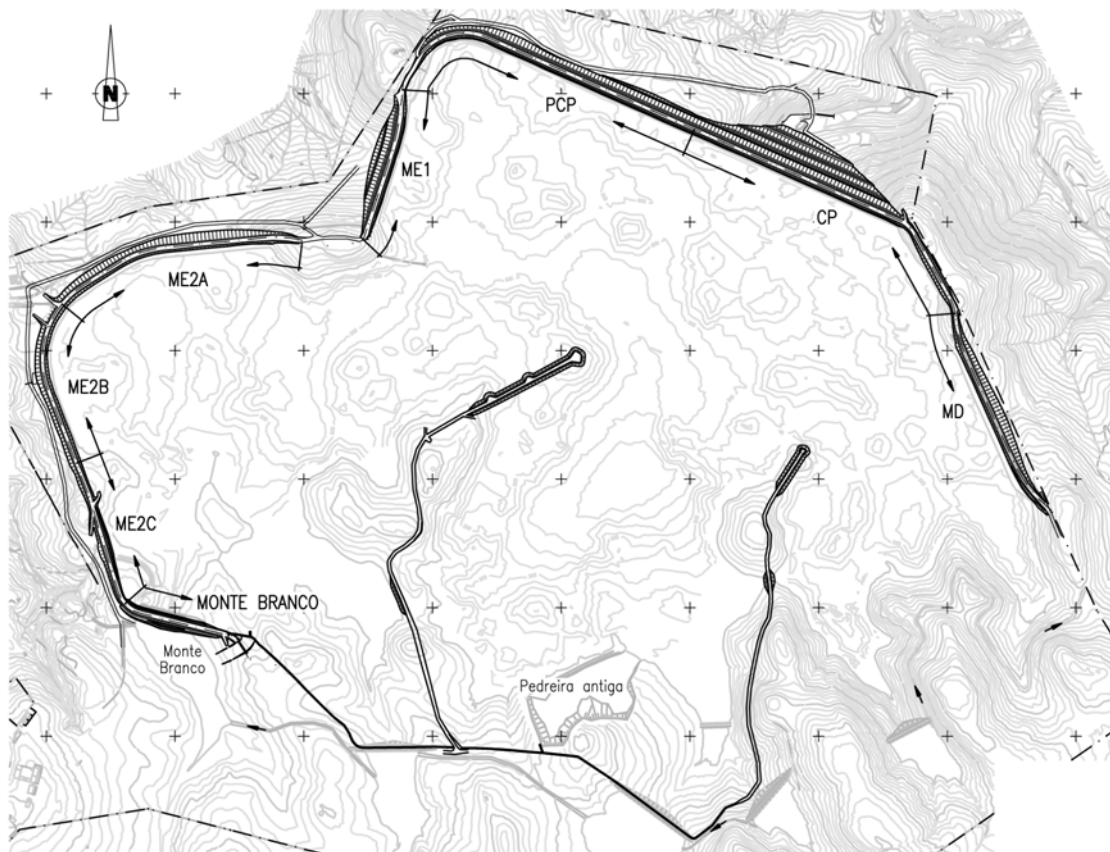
Planta geral da barragem e do desvio das águas pluviais
